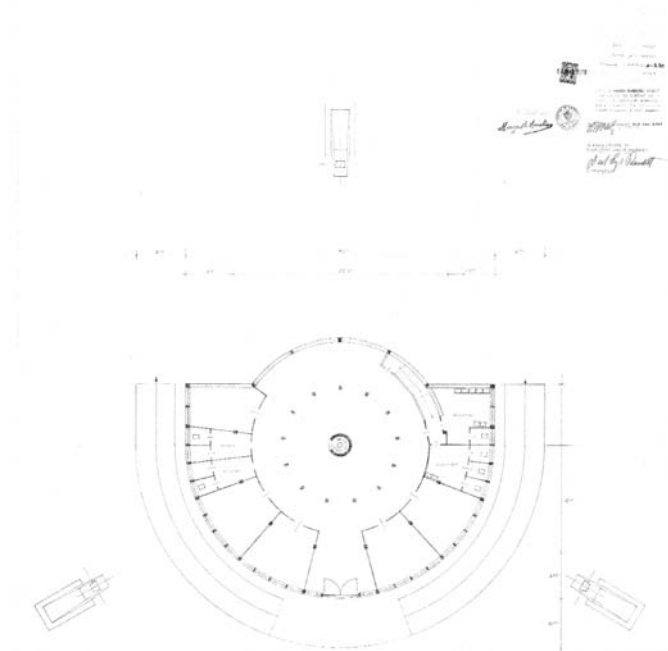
(AAB) - La pianta del piano interrato nel progetto del 1959
